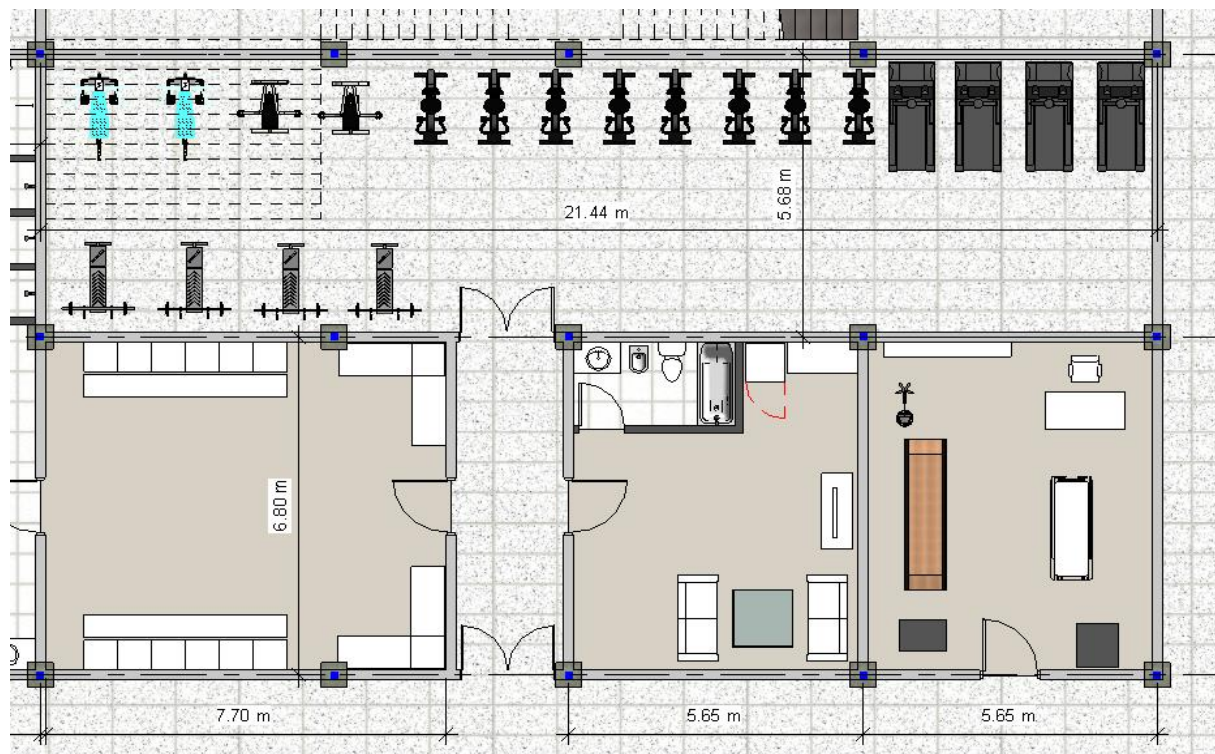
Vista en planta de un fragmento del sector norte del primer piso, donde se encuentran los gimnasios. Fuente: elaboración propia.
